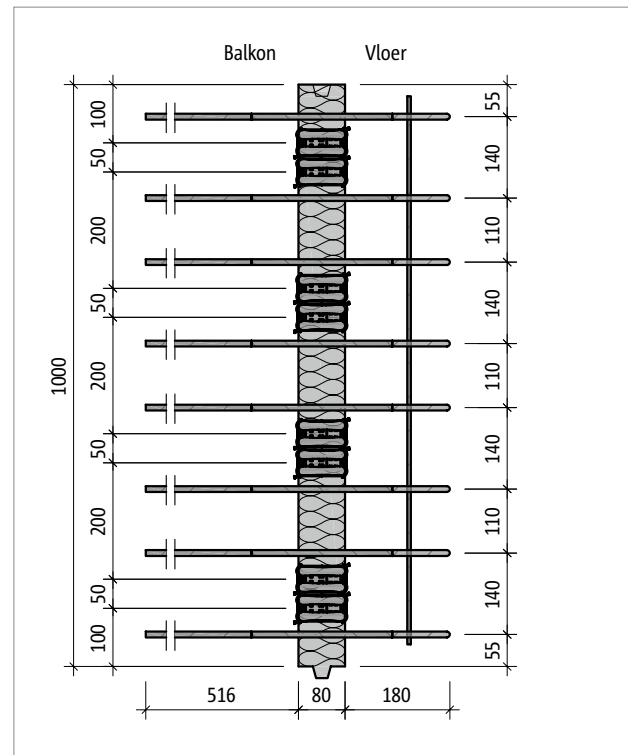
Schöck Isokorf® T type Q-E-V5: Zijaanzicht
